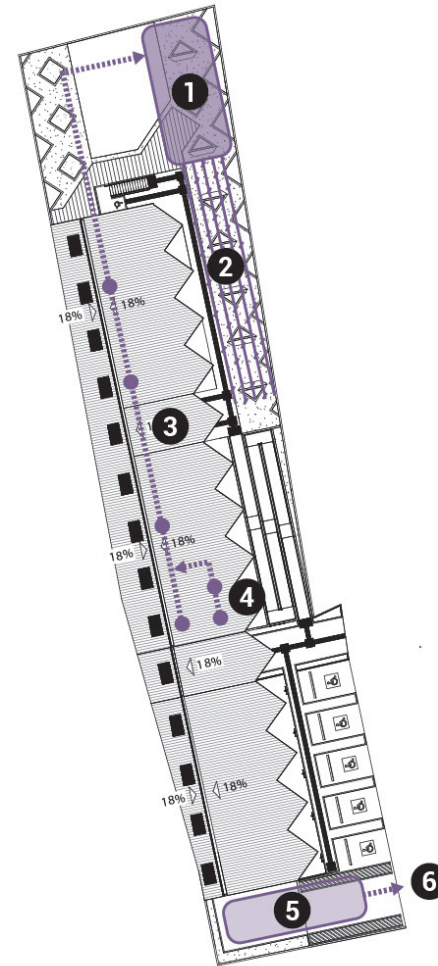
Planta diagrama de instalaciones. Elaboración propia.
